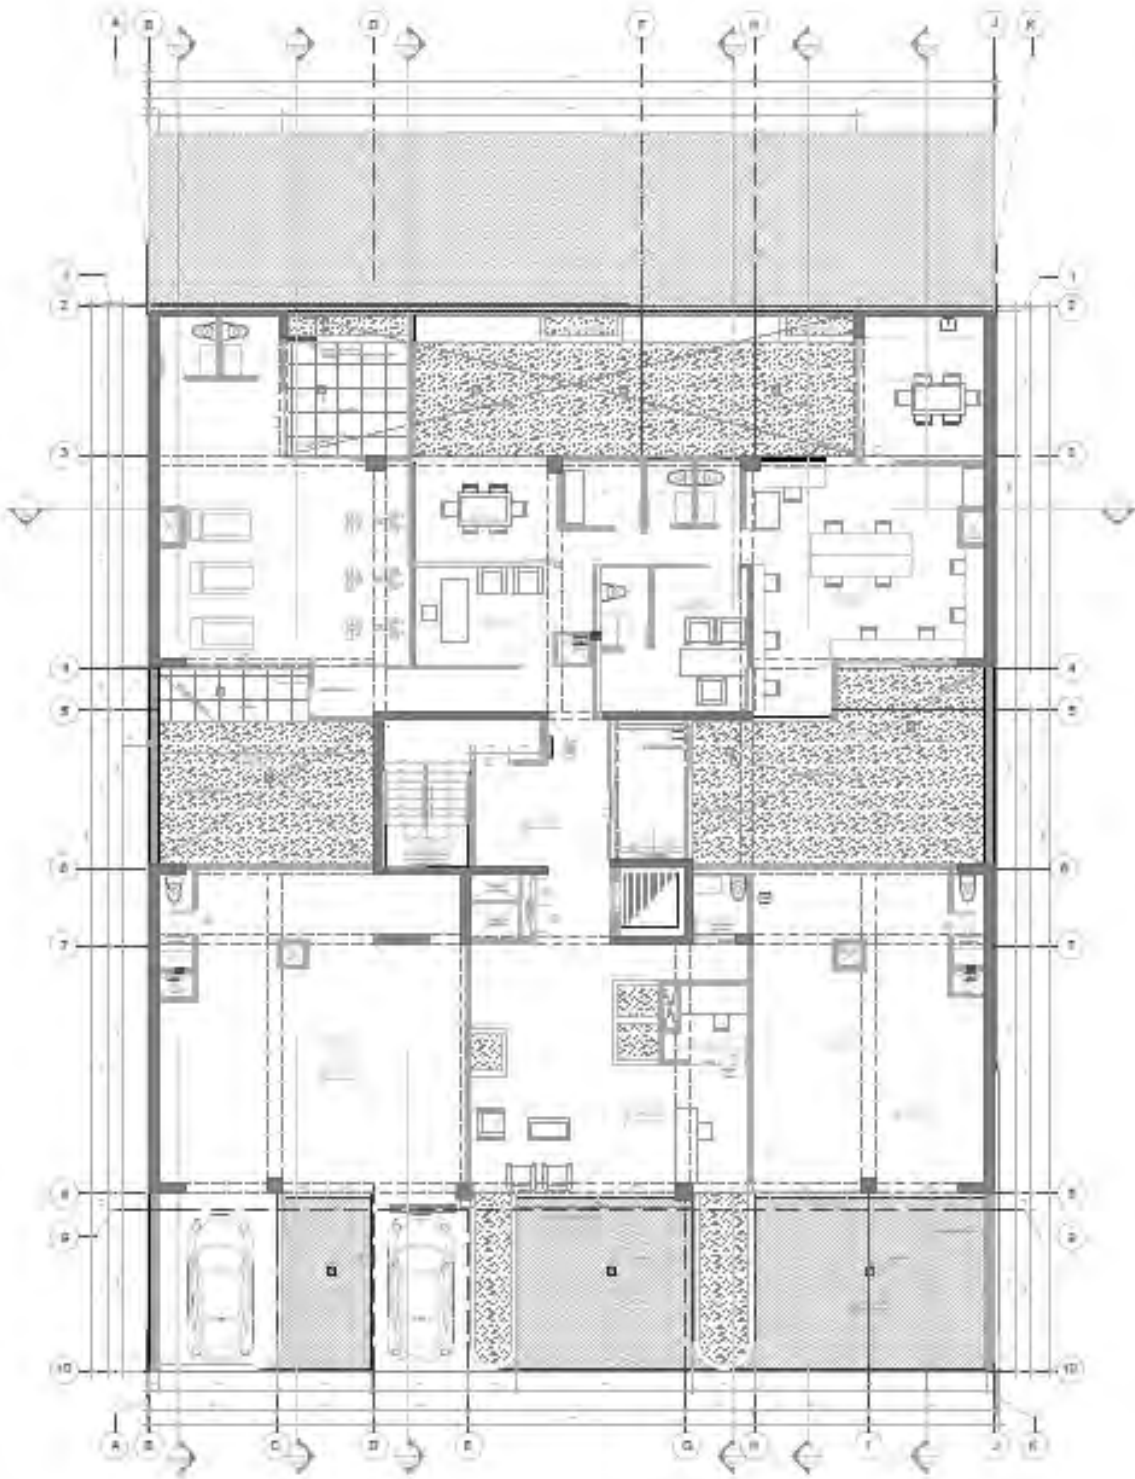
PLANTA DEL PRIMER PISO
